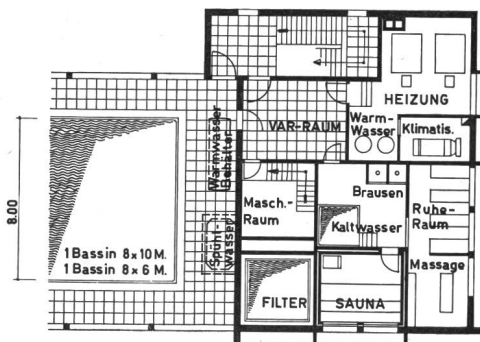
Grundriss Erdgeschoss Nebenräume im Erdgeschoss auf gleichem Niveau wie Turnhalle
